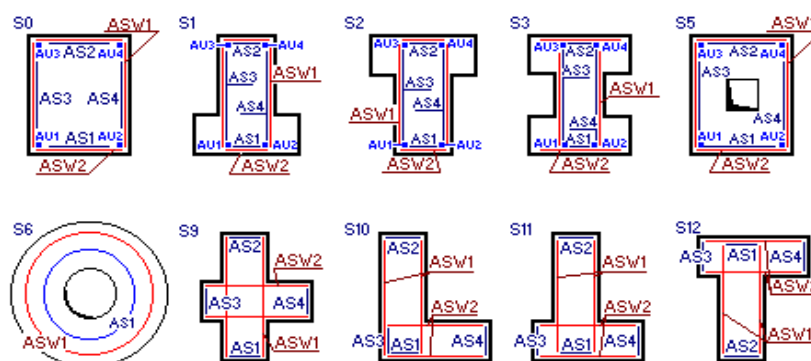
Розташування арматури в залізобетонних перетинах стержнів.
